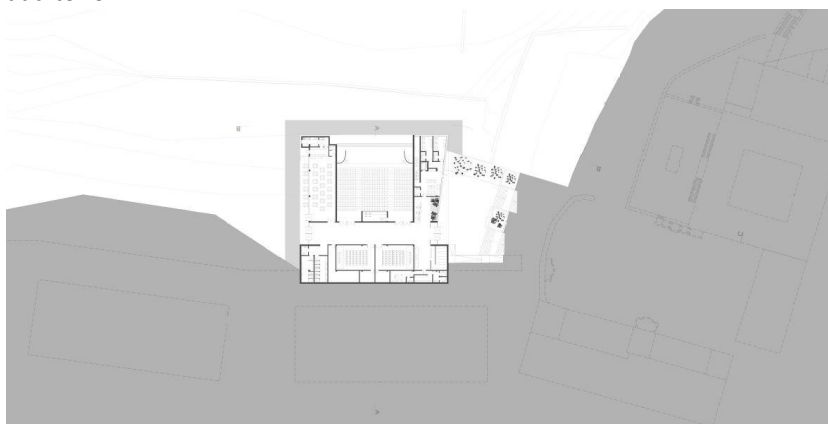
Planta Escola Agrícola, Piso -1 (Auditório)
